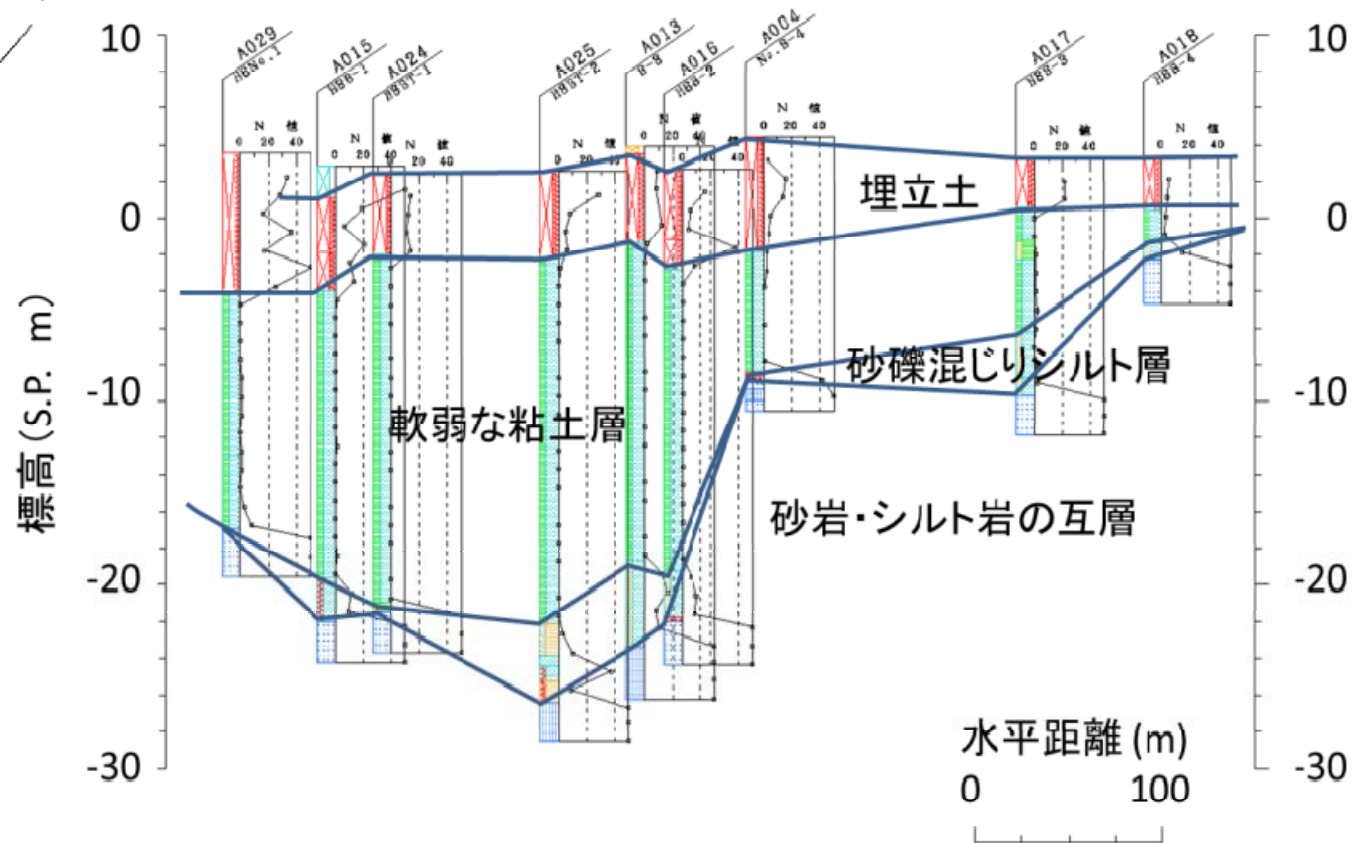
塩釜市新浜地区の地盤調査位置と地質断面図 (A-A断面)
